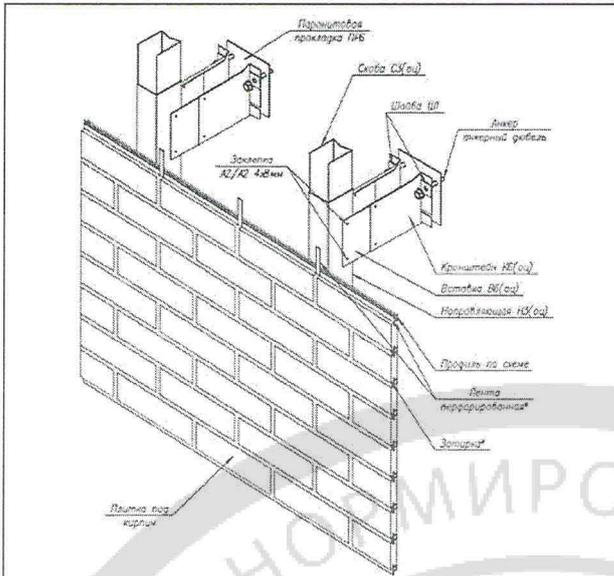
Система с облицовкой плиткой под кирпич на профиль П1 и затиркой швов (крепление в межэтажные перекрытия)
